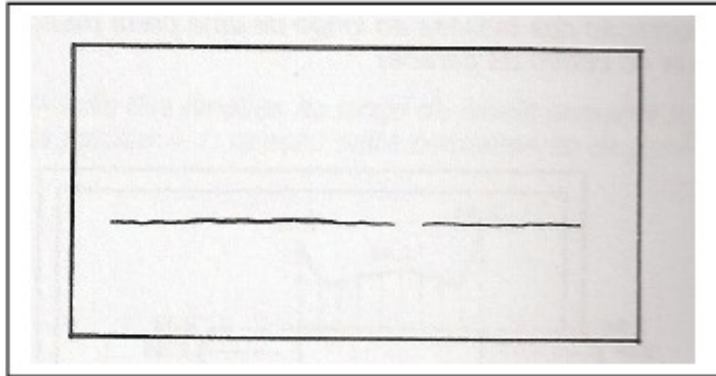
Fissuras horizontais na alvenaria provenientes de sobrecarga
